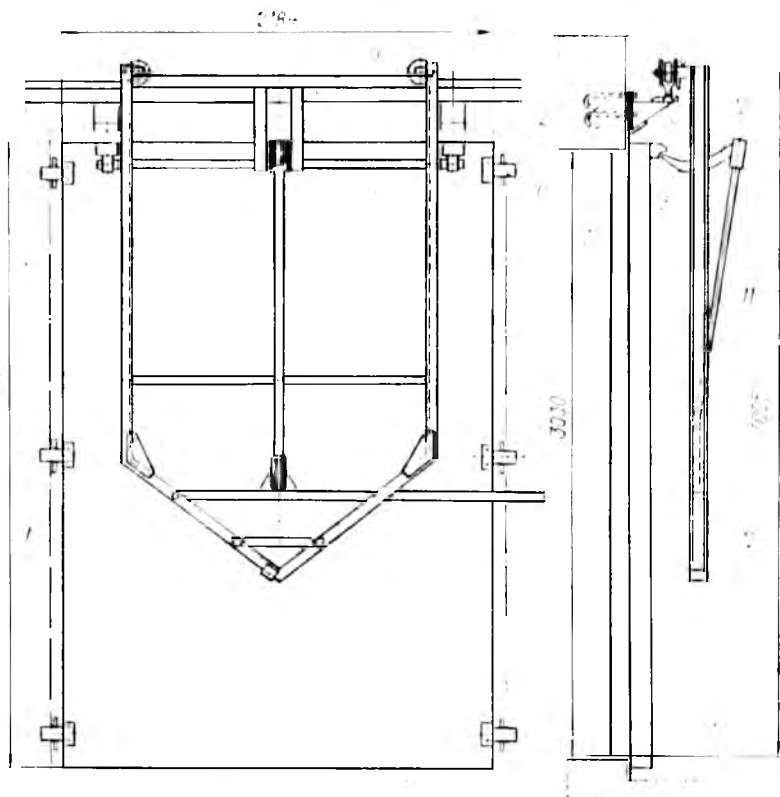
Дверь сушильной камеры с механизмом для передвижения (для камер типа ЦНИИМОД-32):
